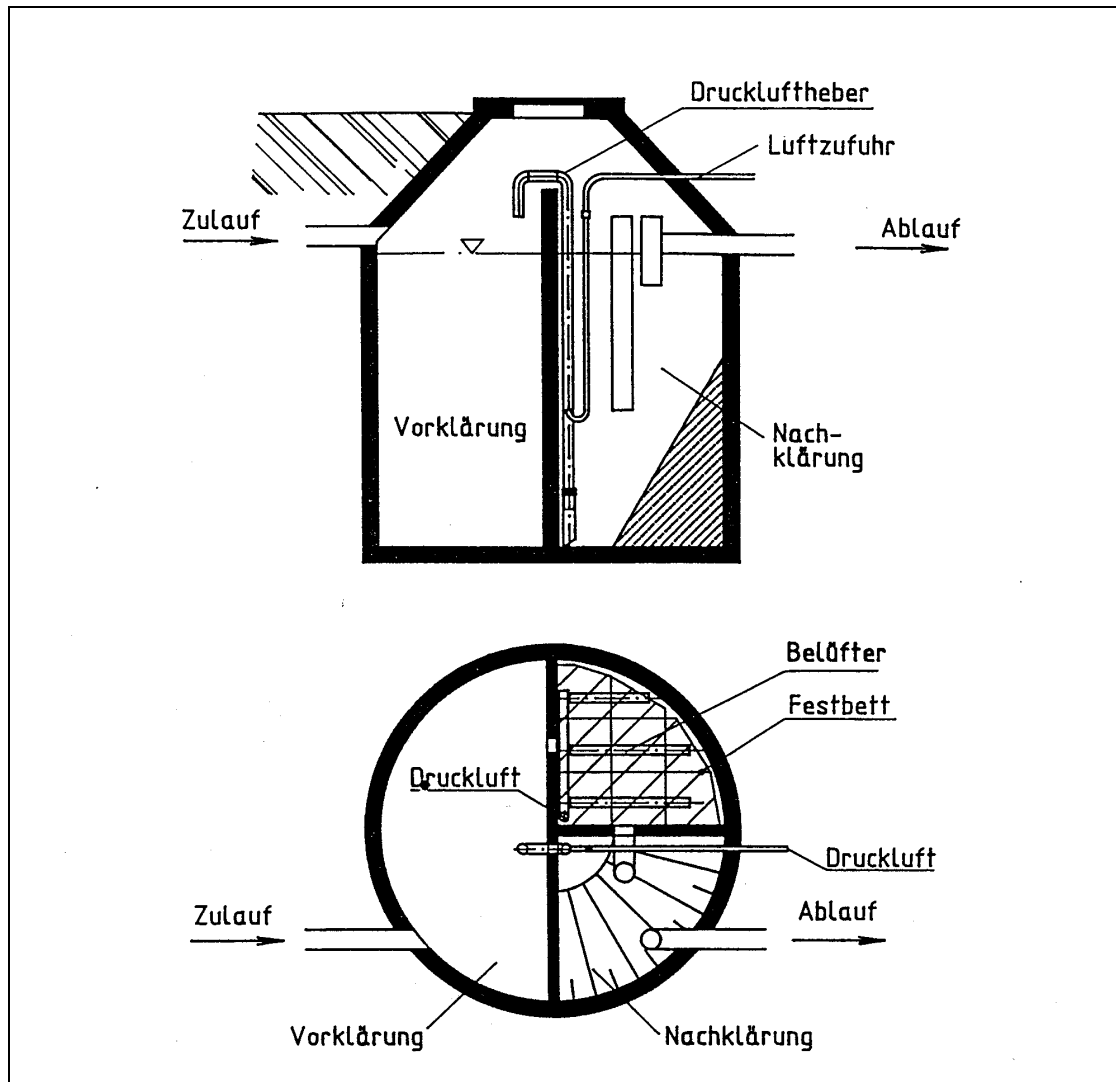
Mit Festbett-System nachgerüstete Mehrkammergrube – Einbehälteranlage (Fa. Envicon)
